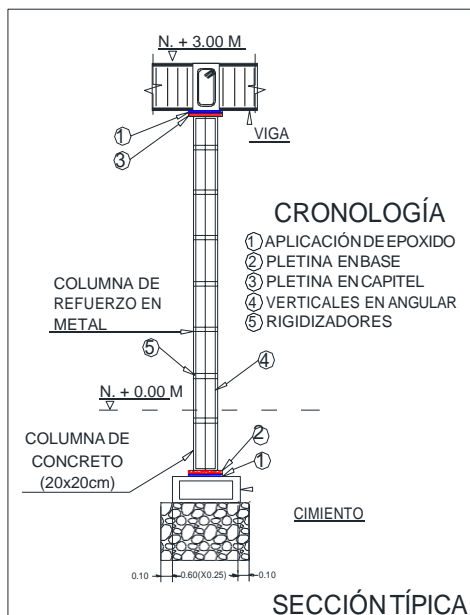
VISTA EN ALZADO DE LA COLUMNA.
